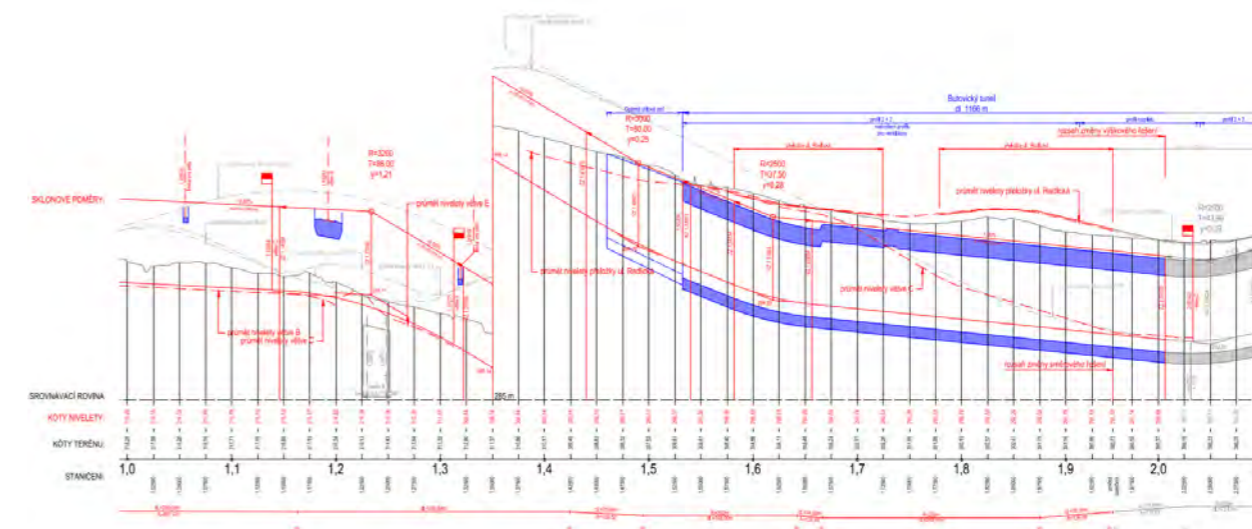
Úsek Botanica – podélný profil RR varianta A
